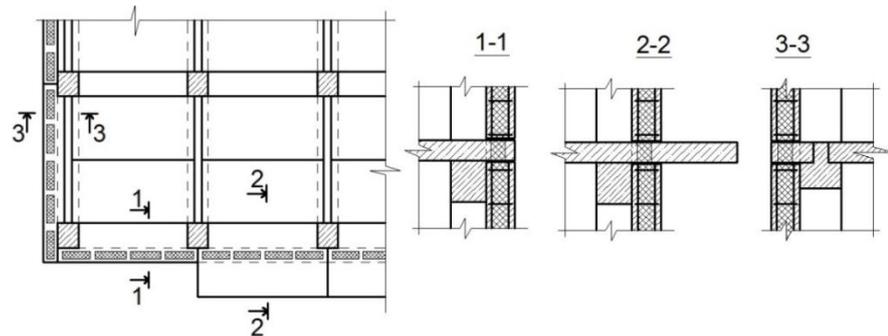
Фрагмент плана типового этажа здания. Характерные сечения
